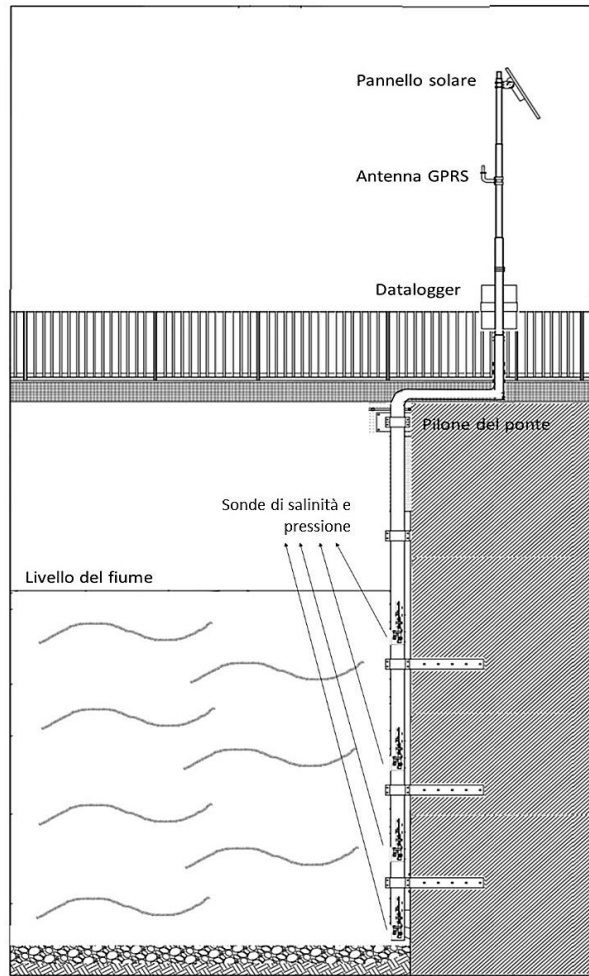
Esempio di progetto dell'installazione di più sonde di salinità al fine di ottenere un profilo trasversale del parametro registrato.
